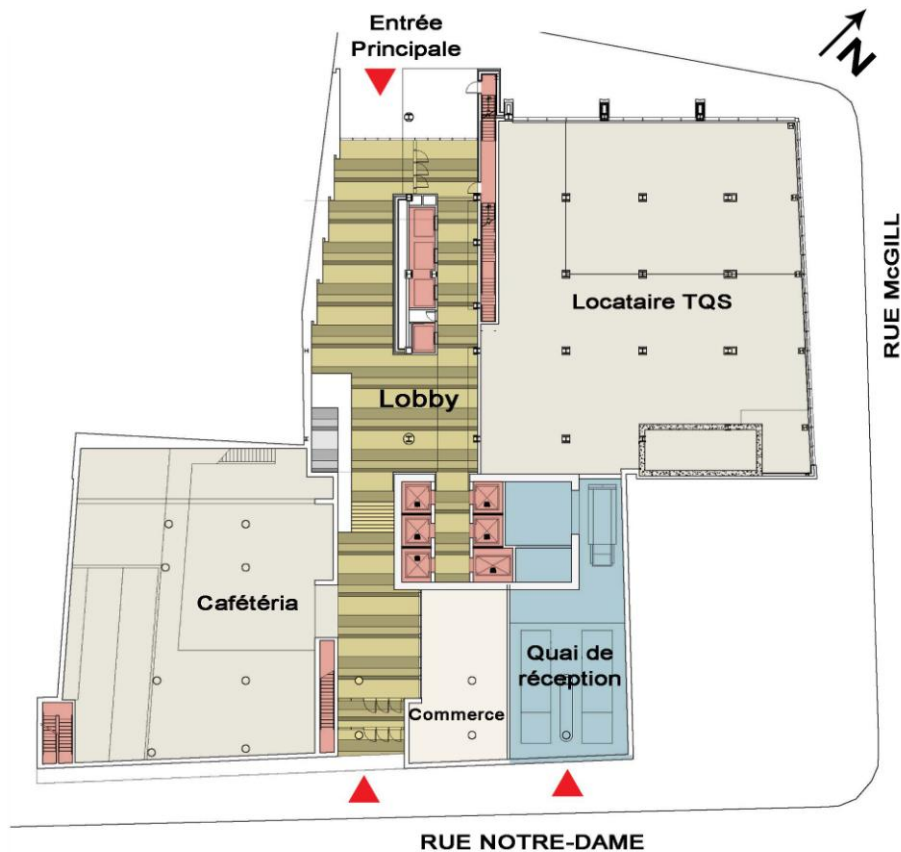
Plan du rez-de-chaussée (Source: ARC/CH, 2006)
